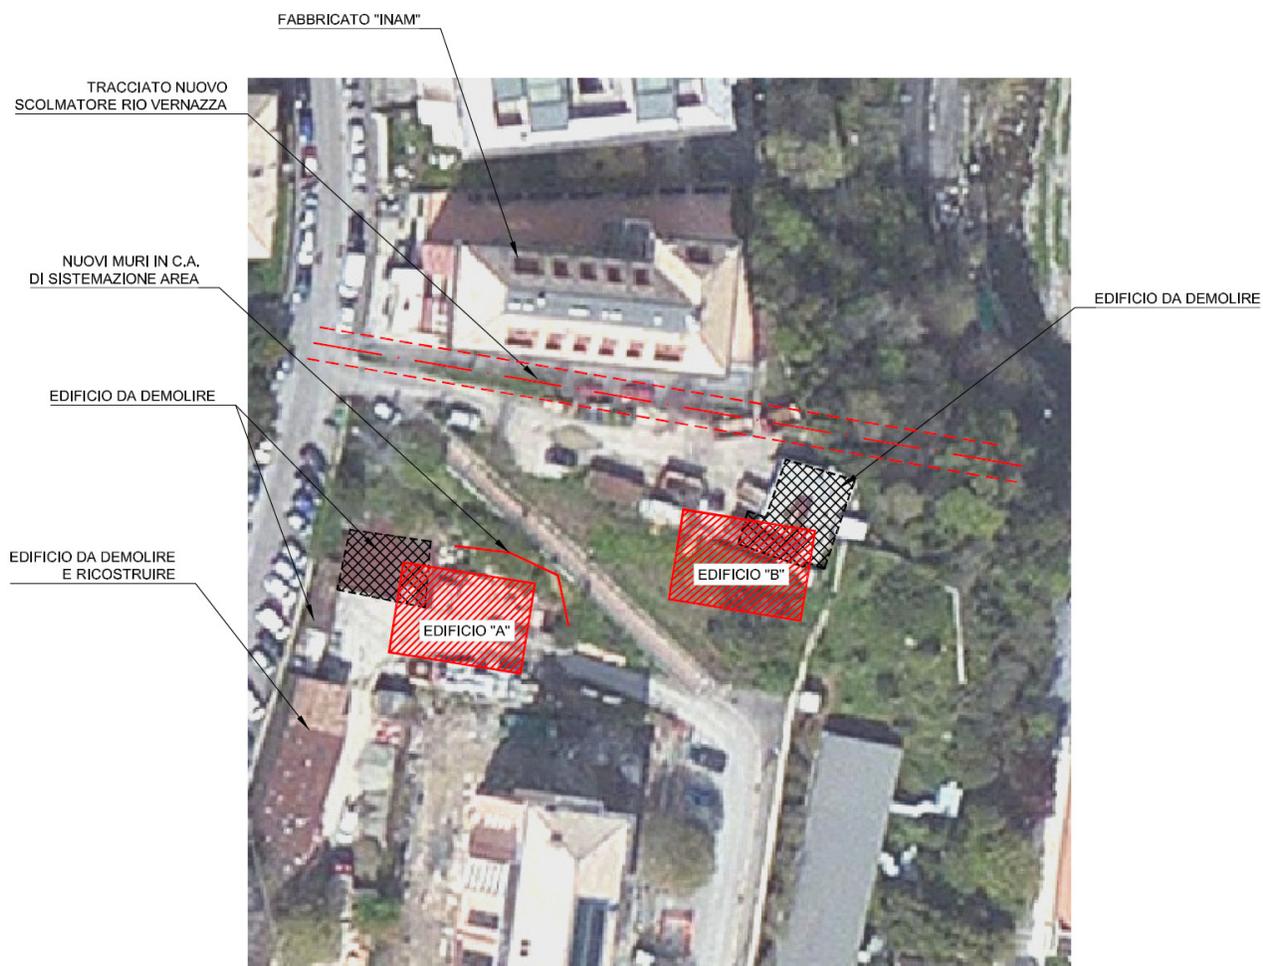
" – Posizione edifici Progetto 2016 su ortofoto dell'area
